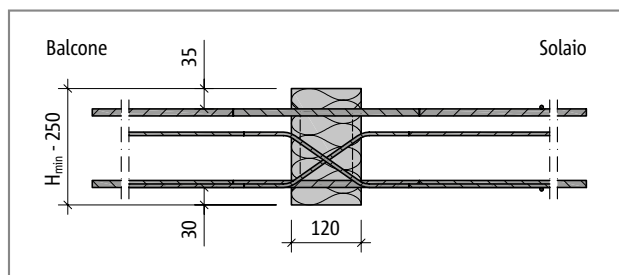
Schöck Isokorb® tipo DXT per CV35: sezione dell'elemento
